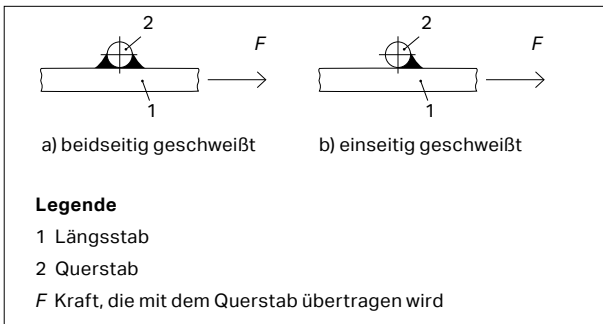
Geschweißter Kreuzungsstoß nach Kap. 6.5.2 – Bild 4
